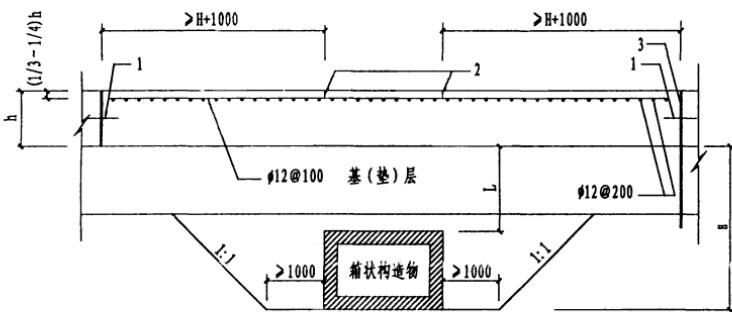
角隅钢筋布置(尺寸单位:mm)
